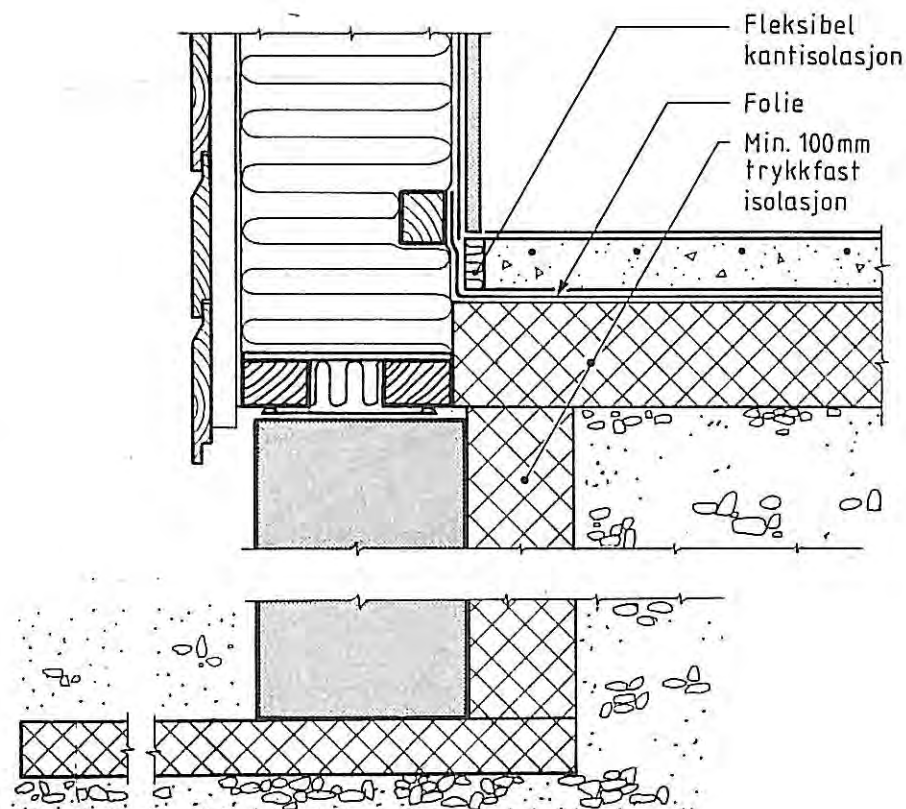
b. Godt isolert gulv på grunnen konstruksjon uten kuldebro ved overgang gulv vegg. Horisontal isolasjon under ringmuren brukes i telefarlig grunn
